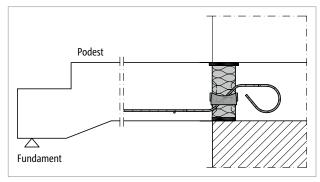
Schöck Isokorb® T Typ QL: Anschluss Treppenlauf bei einschaligem, wärmedämmendem Mauerwerk
